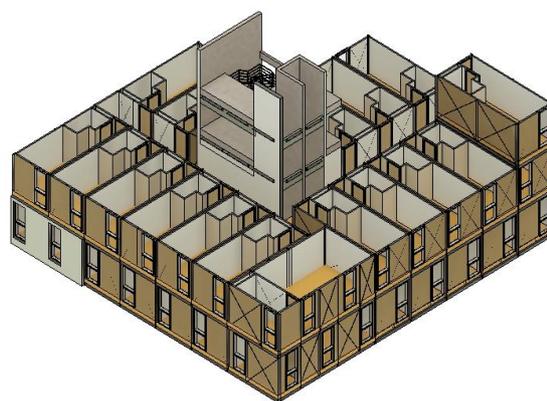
Assemblagem dos módulos do terceiro piso e execução da parede de fachada
